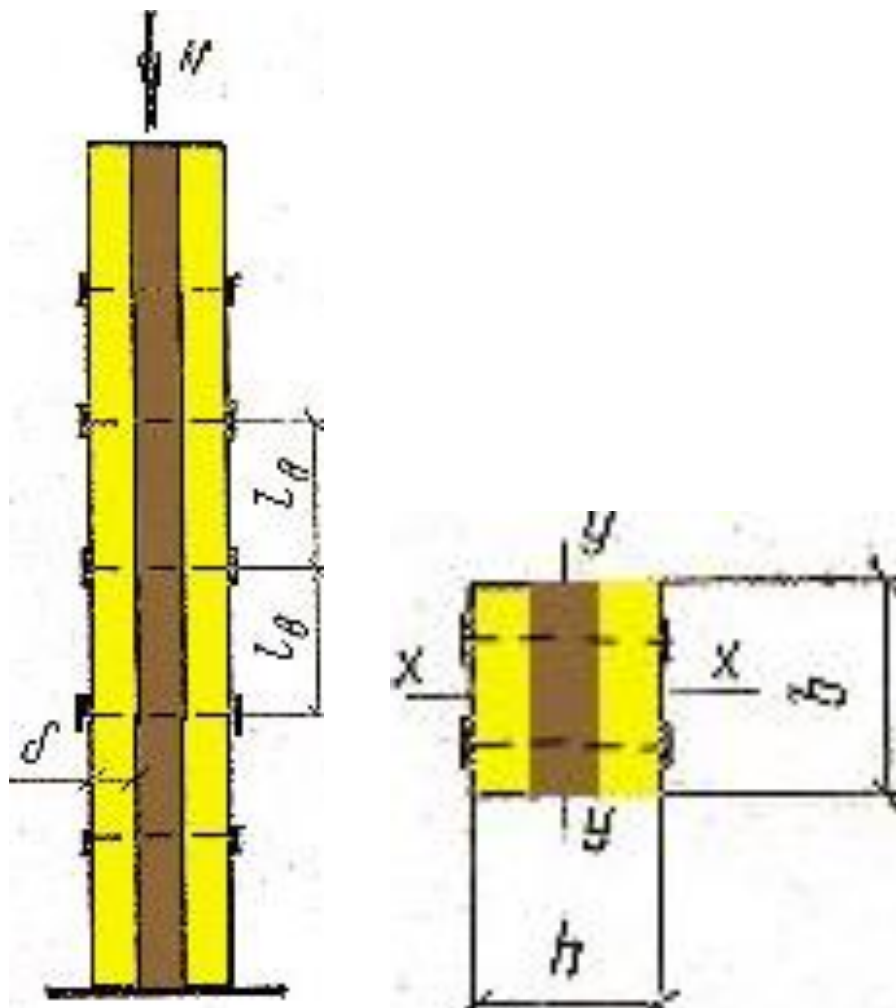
Усиление стоек боковыми накладками, которые участвуют в передаче сжимающего усилия
